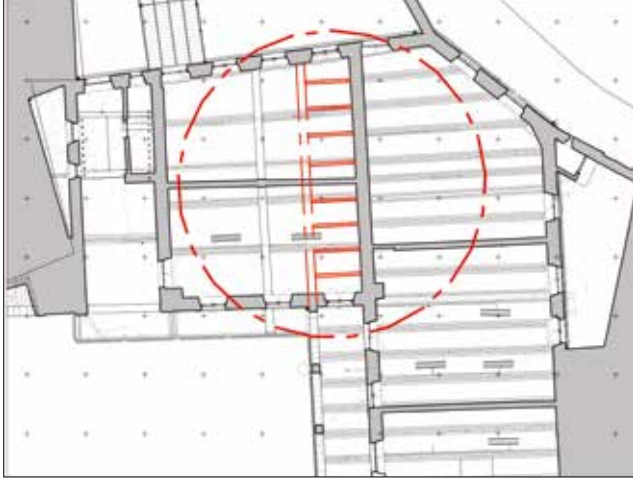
Birinci dönem zemin kat plan şeması (Yazar, 2019). First period ground floor plan.
